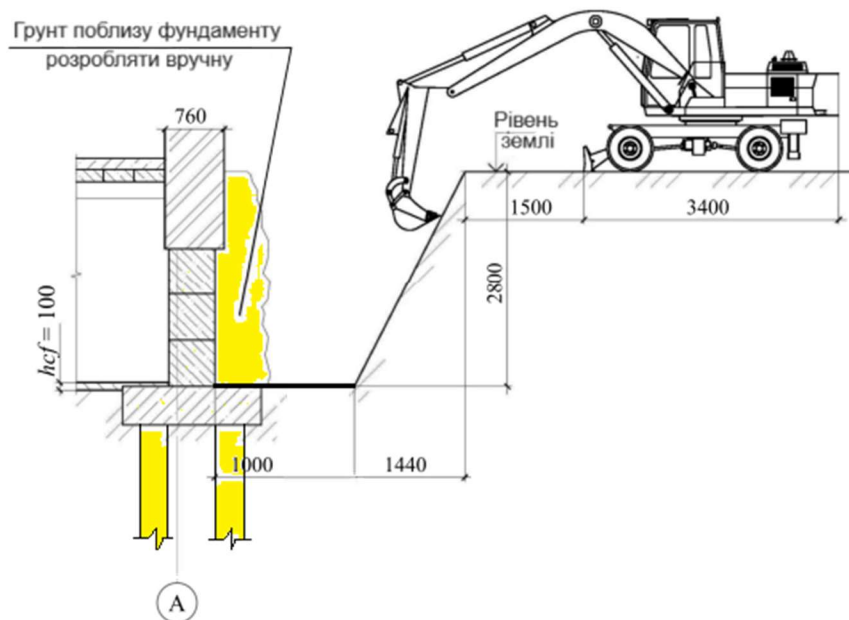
Варіант відкопки існуючого фундаменту
